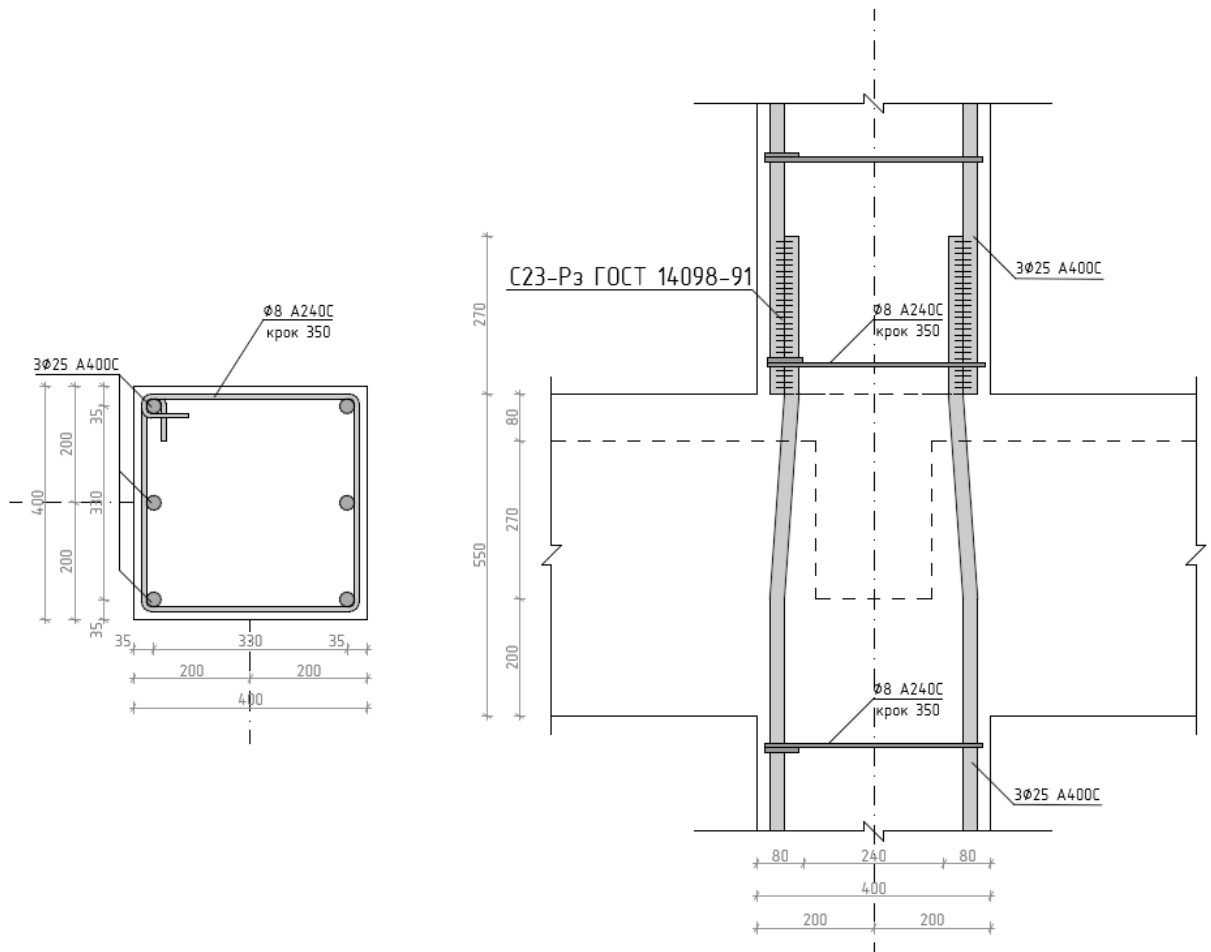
Переріз колони та вузол стикування колон між поверхами
